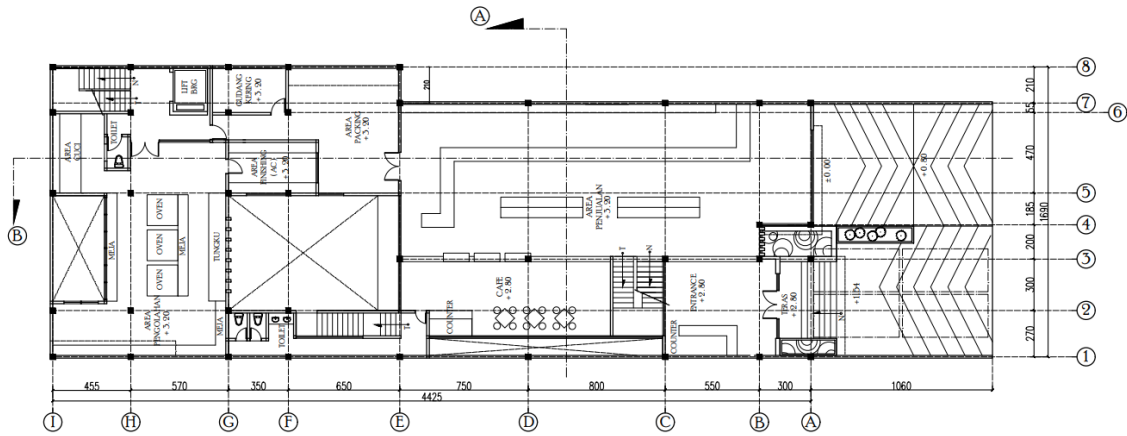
1 Site Plan Prima Rasa Pasir Kaliki Bandung
